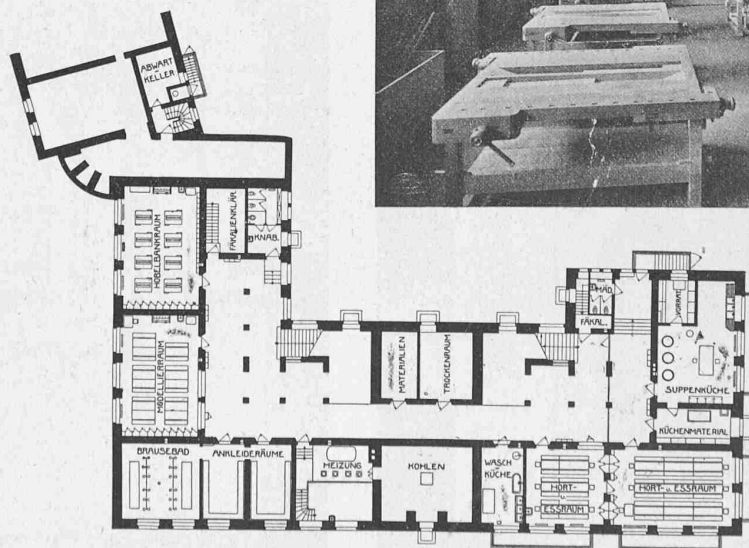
Untergeschoss des Schulhauses. — Masstab 1:600.
